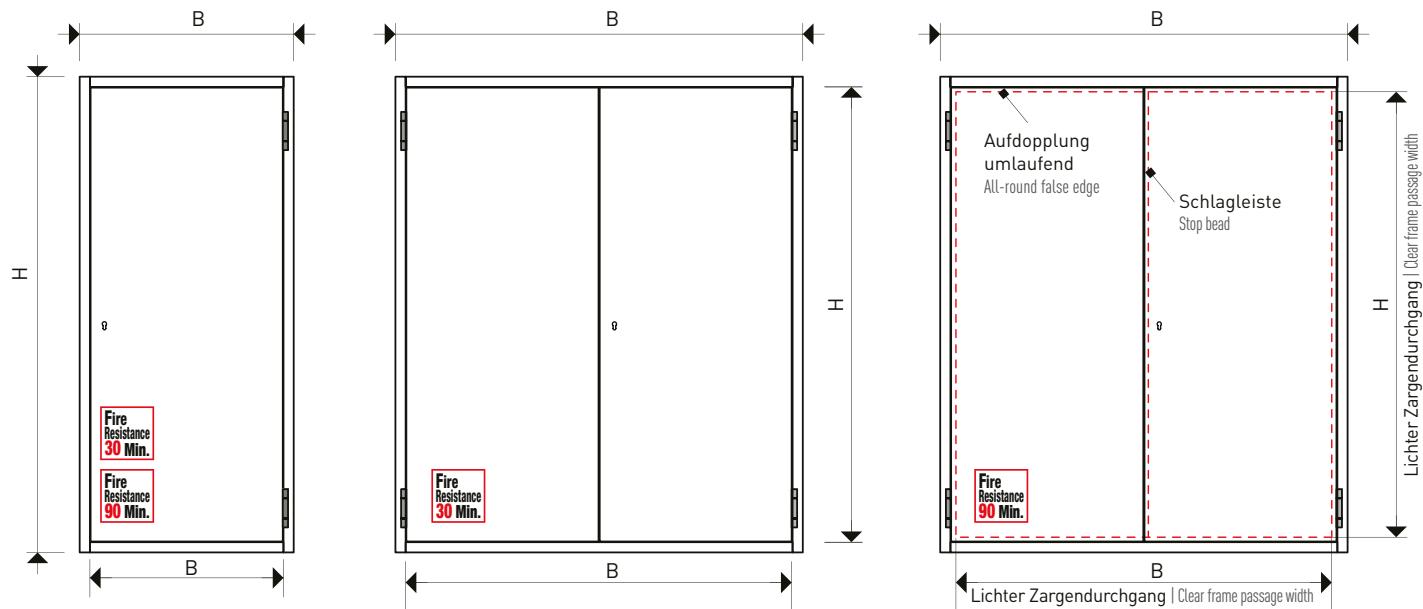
flg. PRIODOOR ETX feuerbeständige Ausführung mit Schlagleiste
